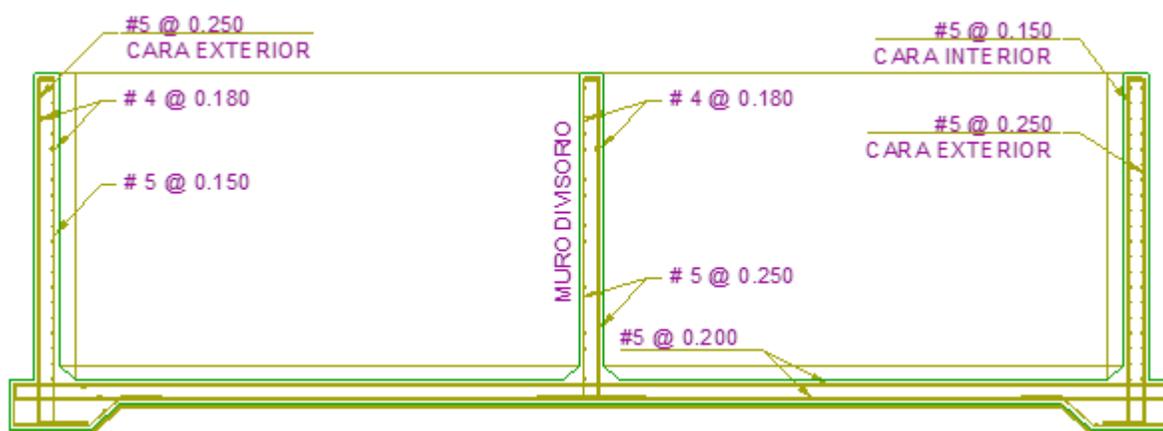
Armado en losa de cimentación de reactor biológico (plano).
